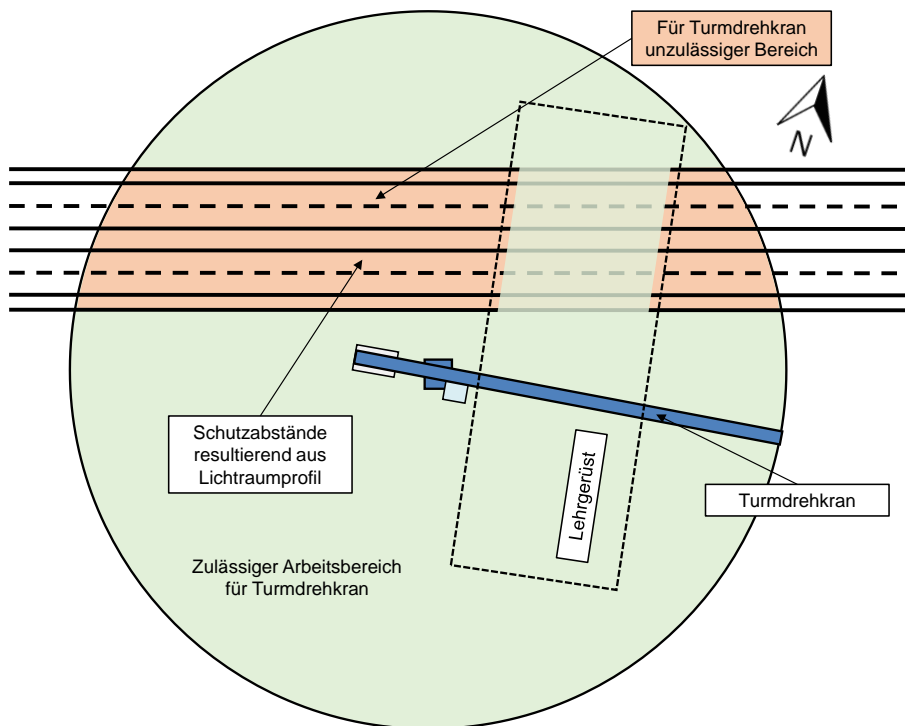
Arbeitsbereichsbegrenzung für einen Turmdrehkran mit dichtem Schutzgerüst (Lehrgerüst) bei Betrieb einer hochrangigen Straße²⁷⁵
